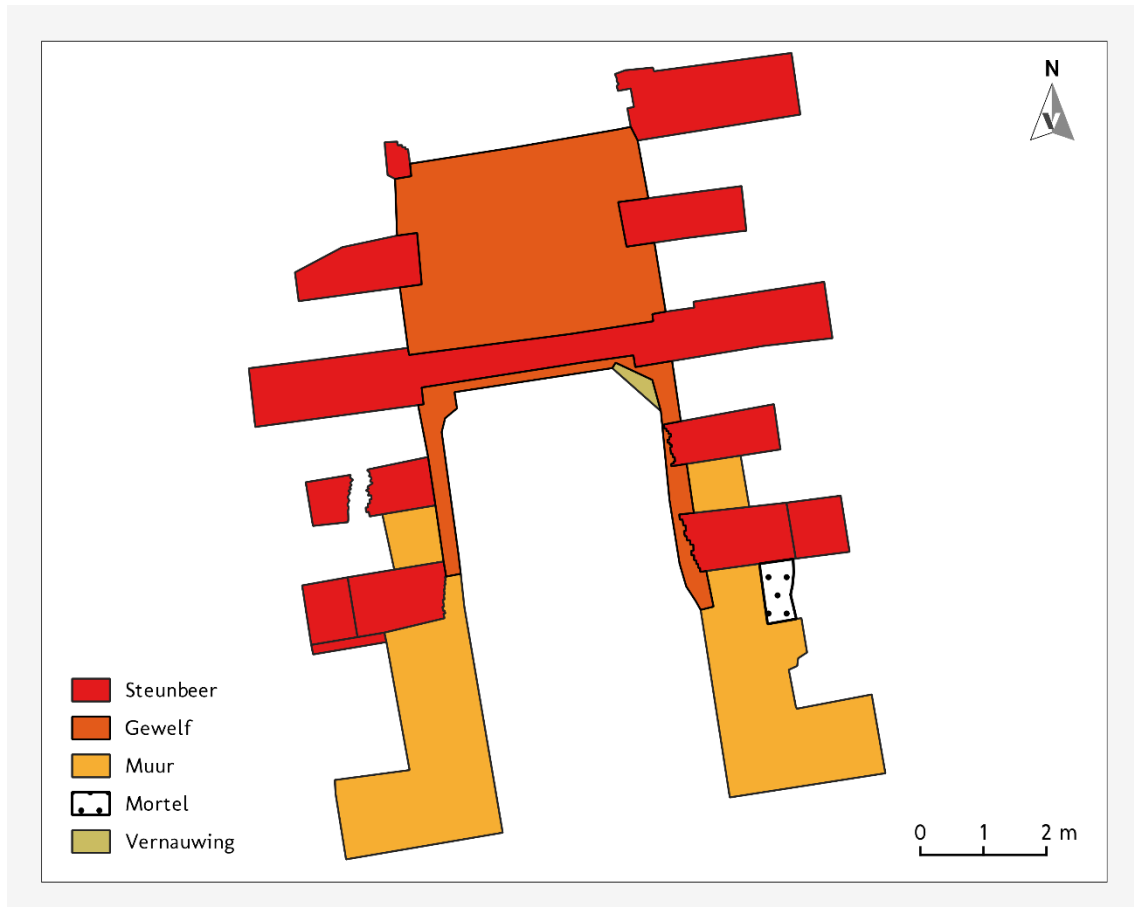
Bovenaanzicht van de sluisconstructie. Noorden is aan bovenzijde van de foto. Foto: BVL De Winter.
